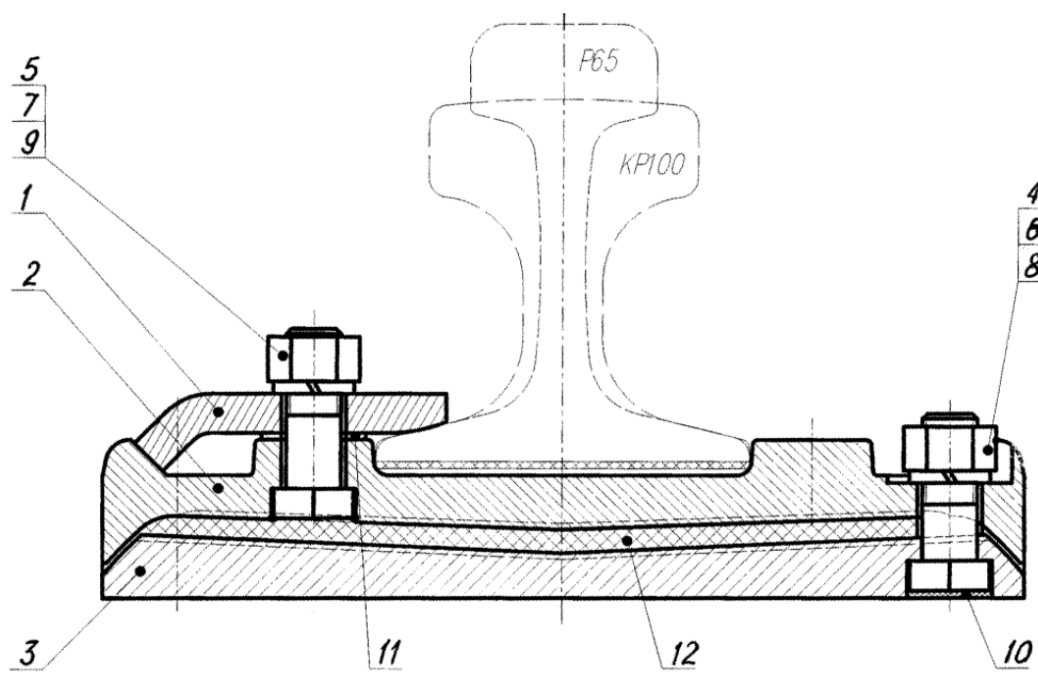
Универсальное раздельное рельсовое скрепление для прокладки пути конструкции Ведерниковой
